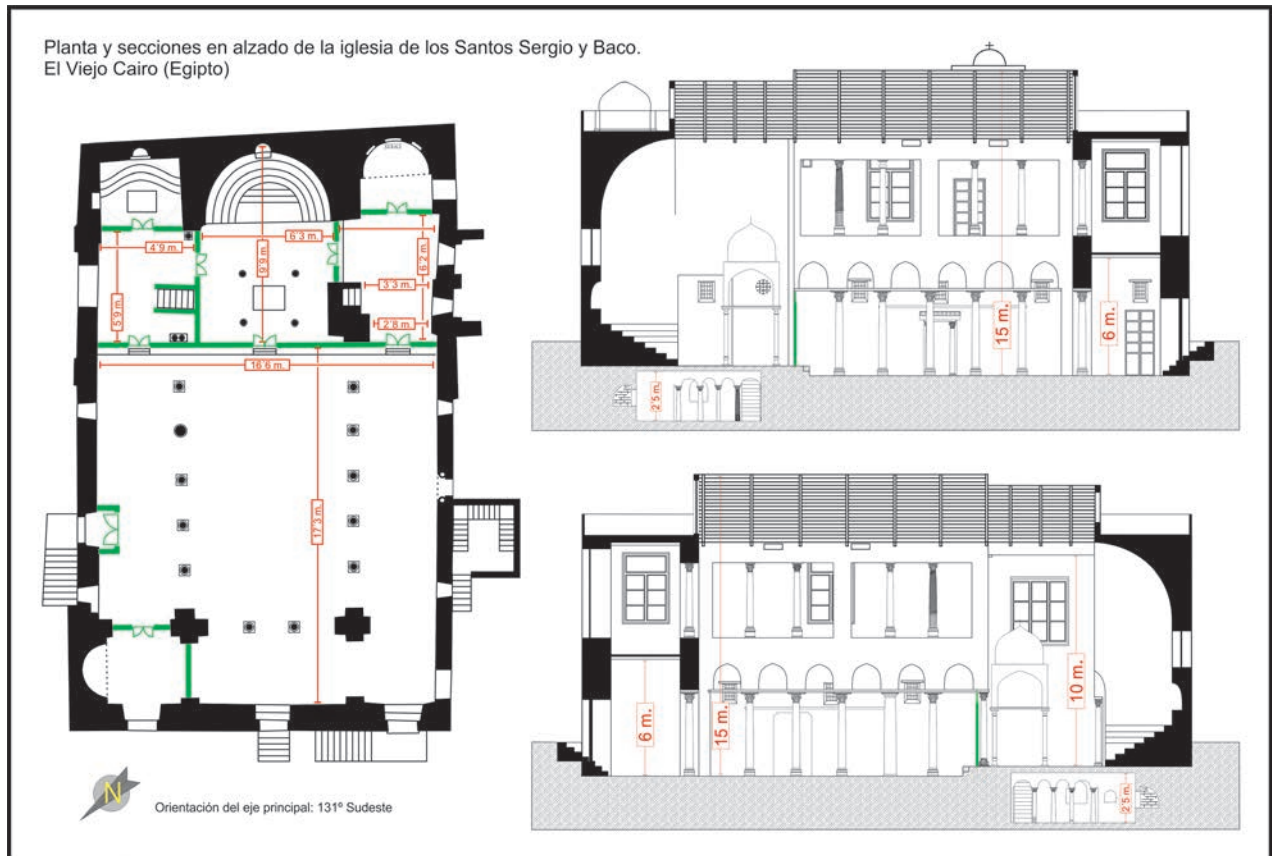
Planta y secciones en alzado del interior de la iglesia de Abu Sirga. Andrés Álvarez.
